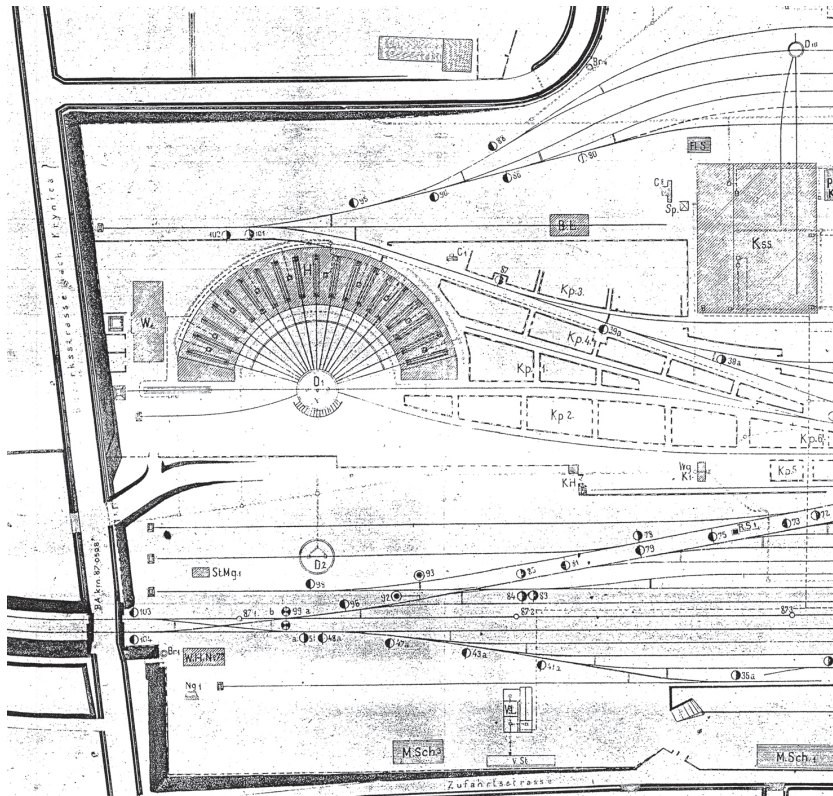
Plan rejonu parowozowni w 1905 roku¹
